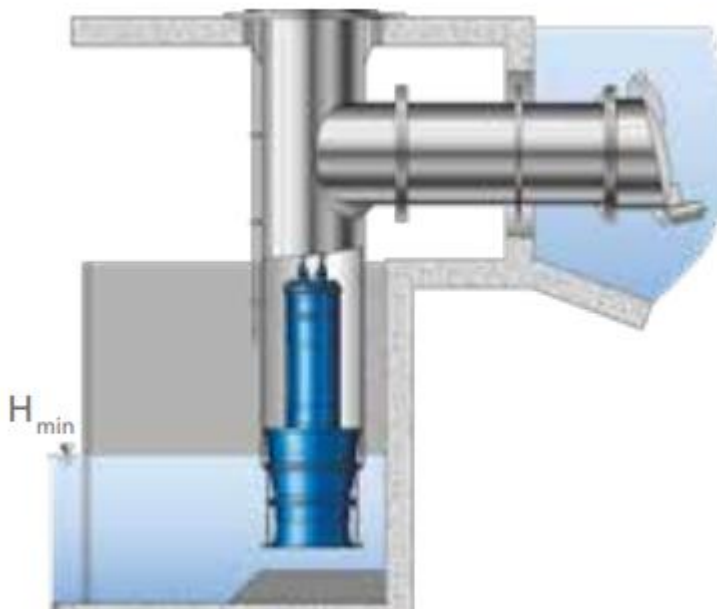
Exemplo de montagem de motobomba em tubulão/tubulação de coluna (H_{min} é o nível mínimo de lâmina d'água)
